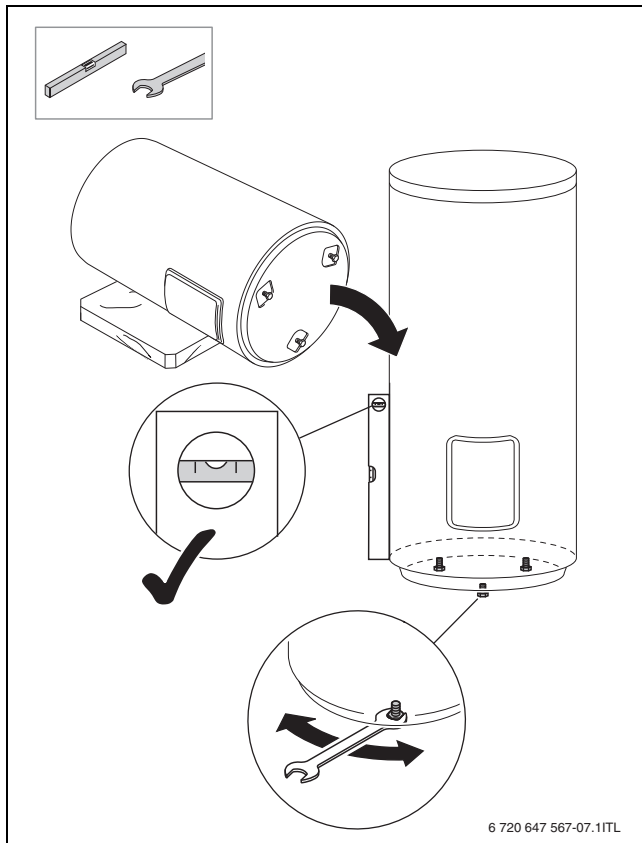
Mise en place du ballon d'eau chaude sanitaire
